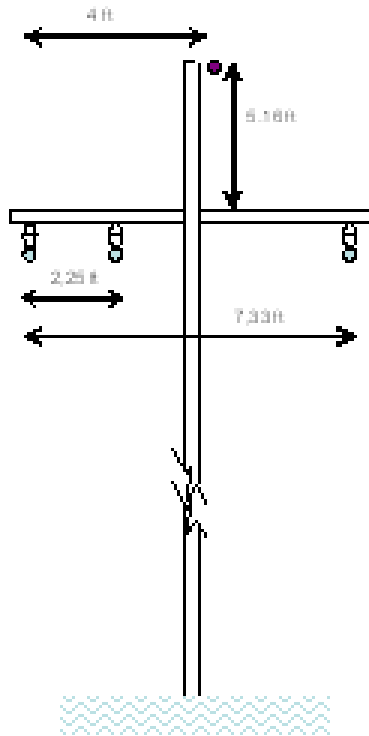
Línea Eléctrica 34,5 kV. Detalle de Elevación.
